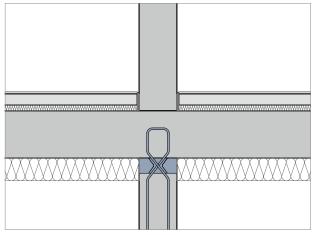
Schöck Sconnex® type W pour mur intérieur et isolation sous la dalle
